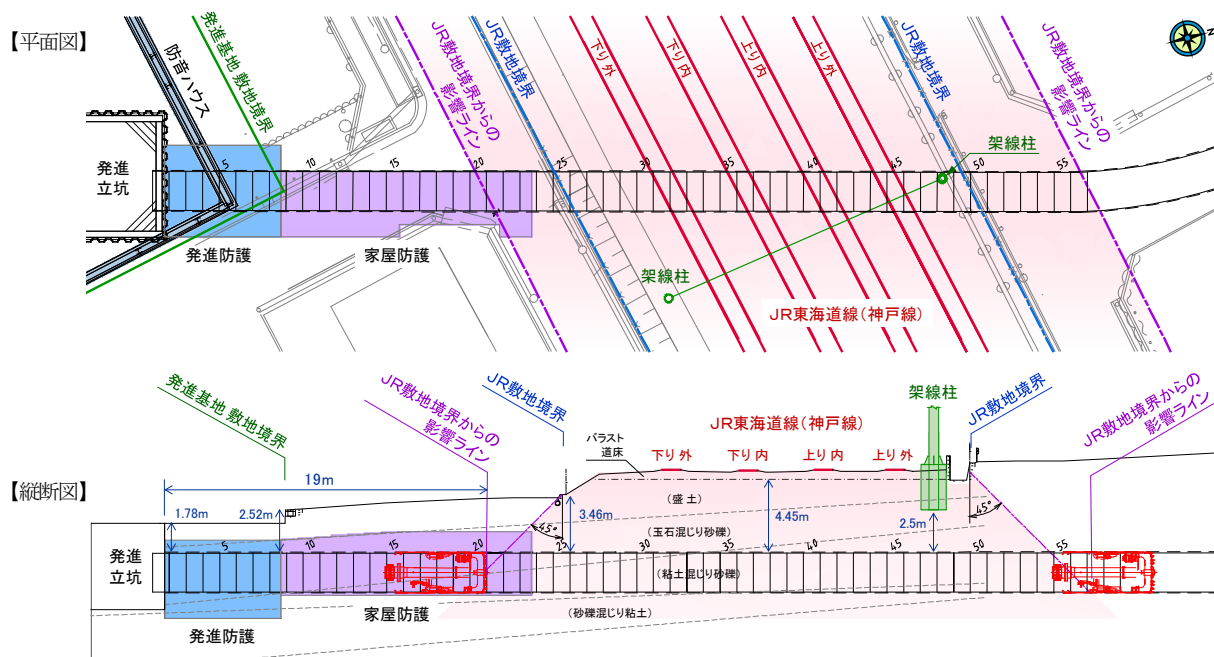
JR神戸線横断面部 概要図（平面・縦断面図）
